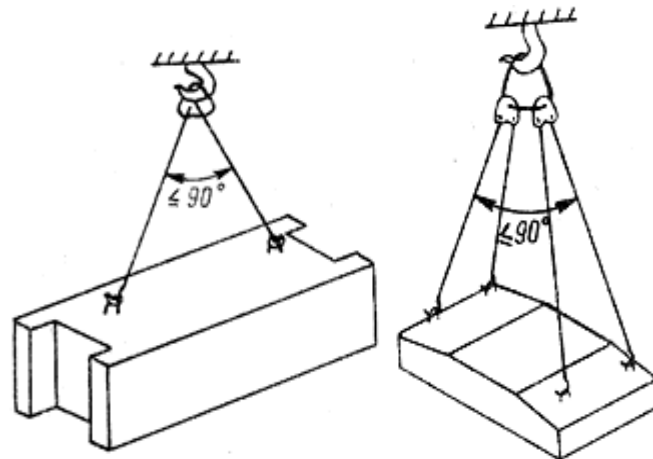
,2 – Схема стропування фундаментних блоків і плит
